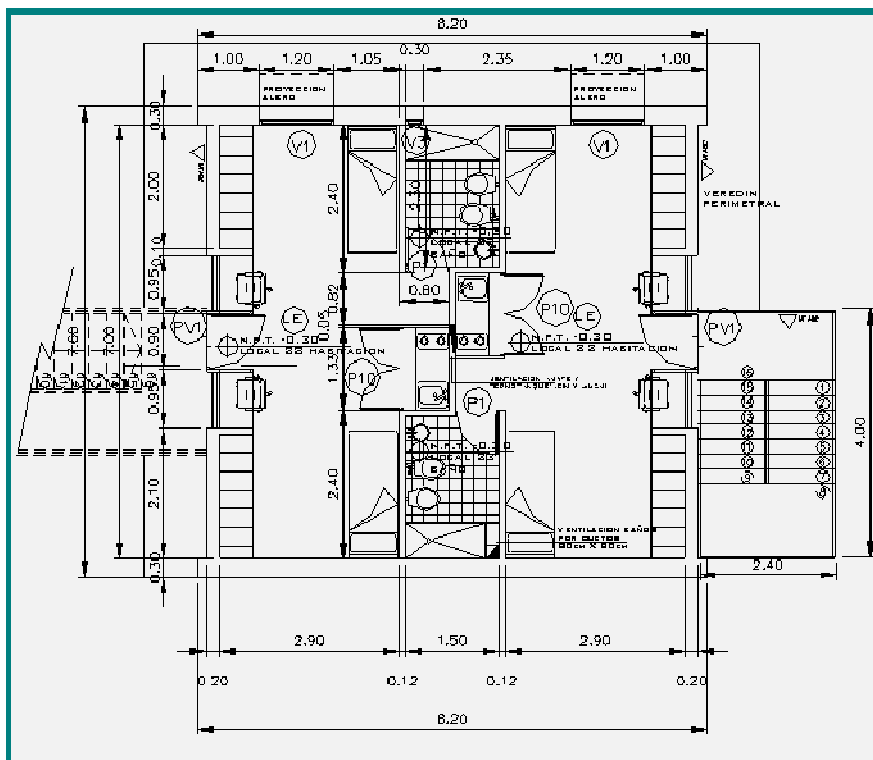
Planta tipo del edificio destinado a dormitorios con aislamiento sísmico.
